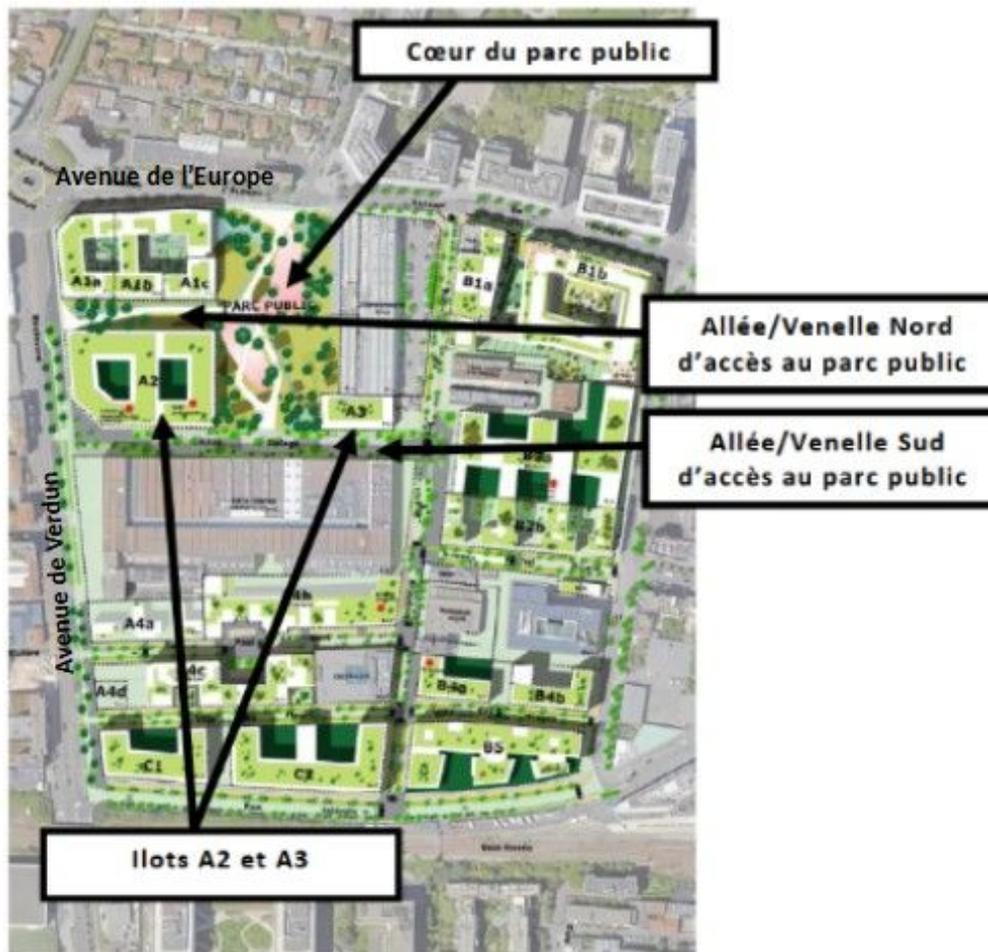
Plan masse - Source : Pièce D Plan général des travaux (p. 3)
